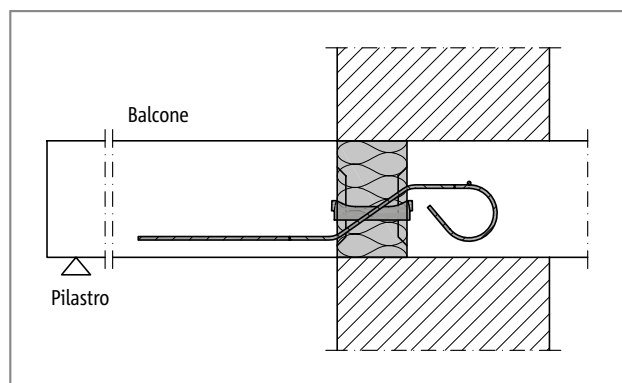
Schöck Isokorb® tipo QXT: raccordo con appoggio su muratura termoisolante monostrato (tipo da QXT10 a QXT40)
